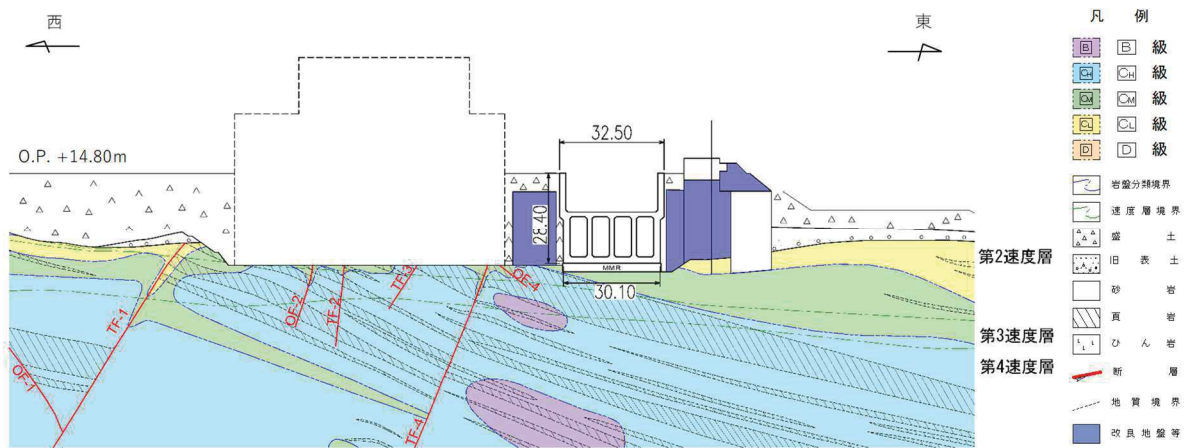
海水ポンプ室の地質断面図 (⑭-⑭断面)
